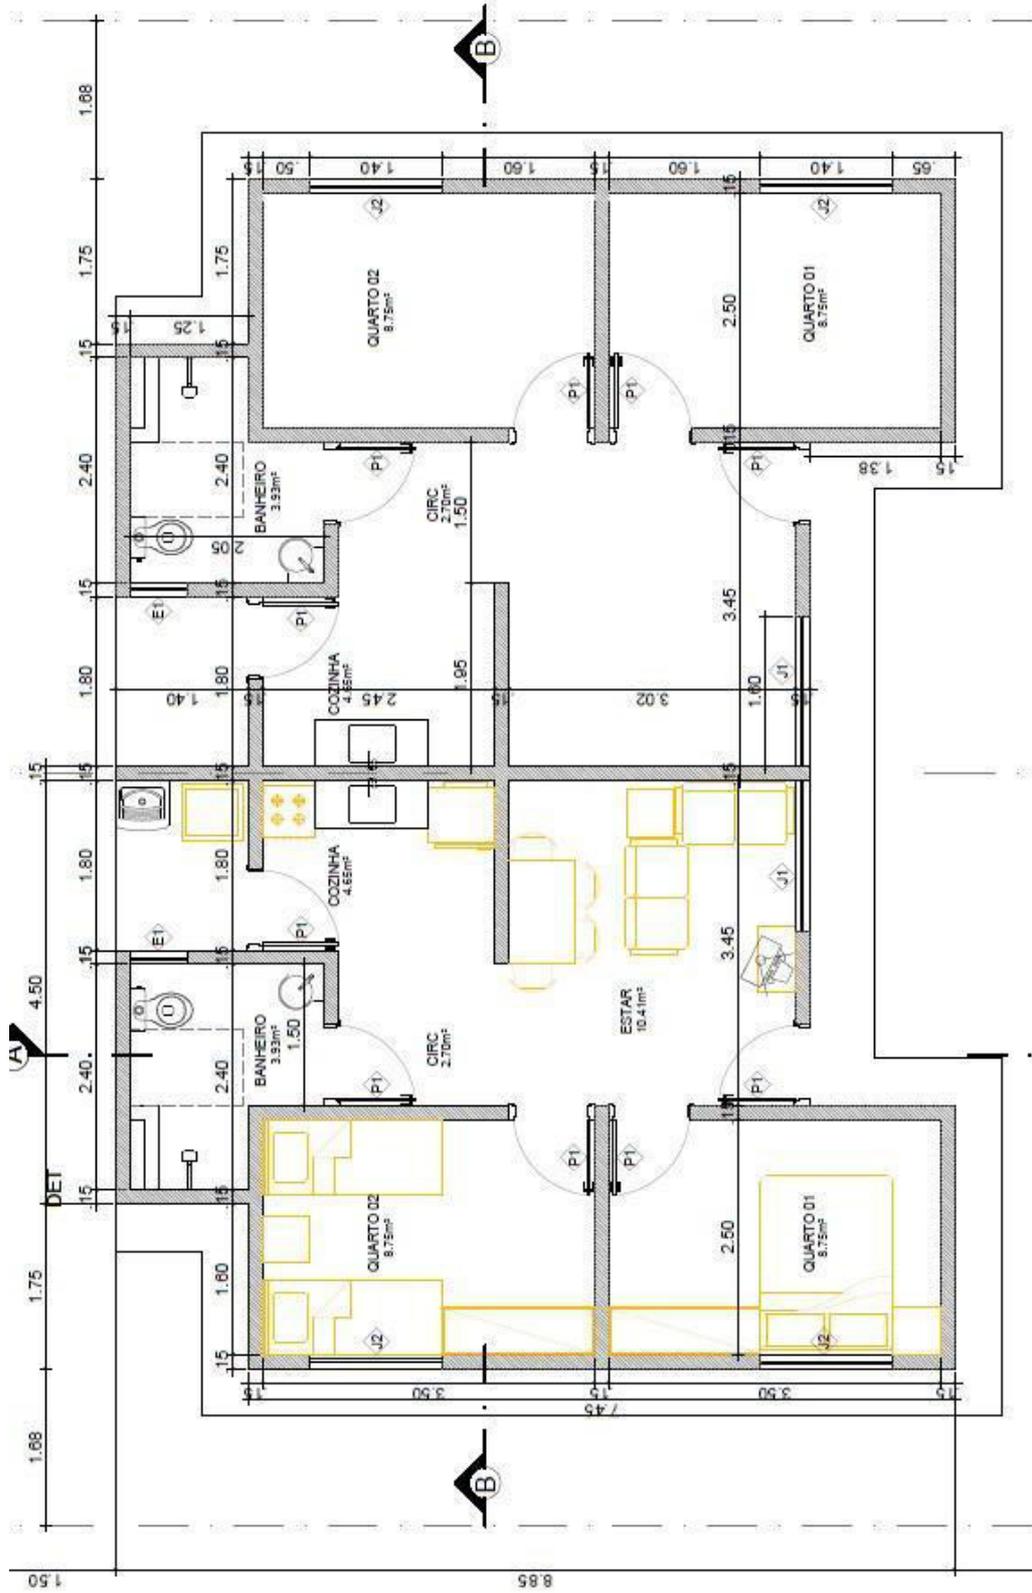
Planta baixa e Planta de Layout das casas construídas no Residencial Amendoeira. Fonte: Arquivo da Gerência de Habitação da Caixa Econômica (2017).
